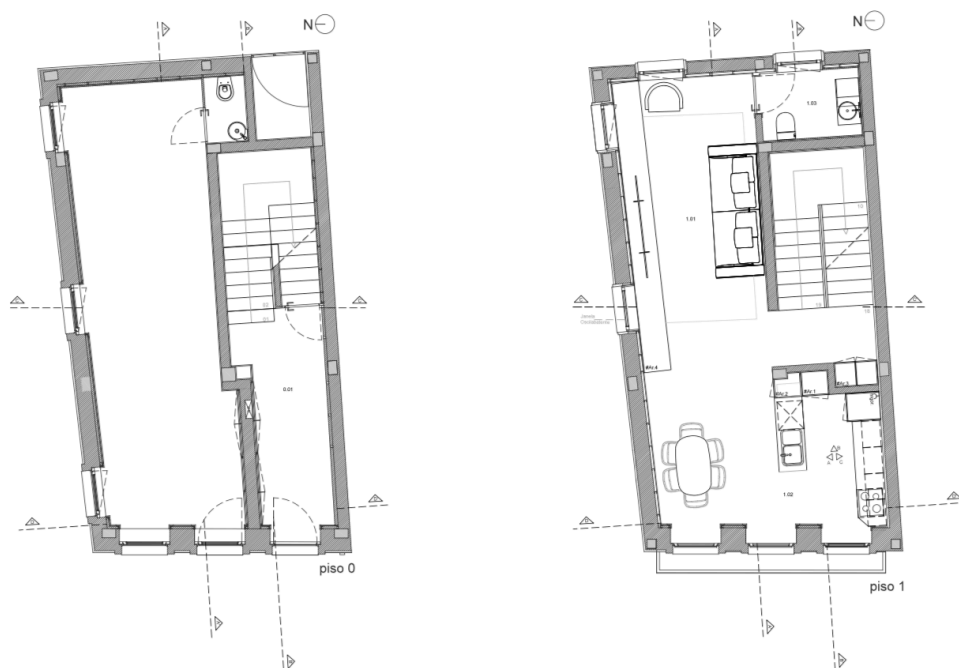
Planta de proposta piso 0 e piso 1. Fonte: Autores
